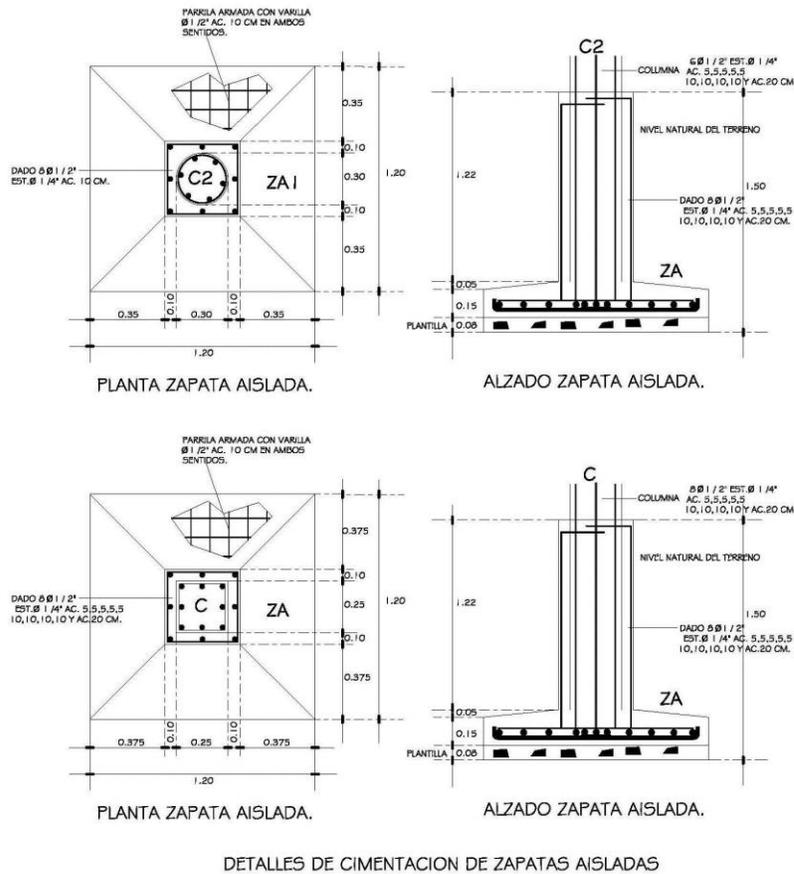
Detalle de cimentación de zapatas aisladas.
